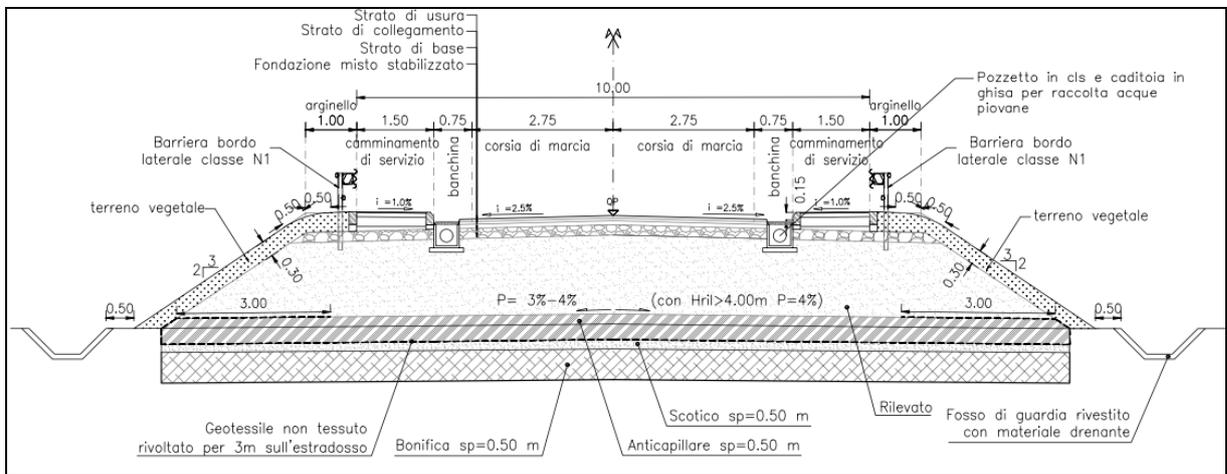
NV_ASSE 2: Ponte stradale sul Torrente Evigno - Sezione tipo in rilevato in prossimità dell'intersezione con via Argine Sinistro.
